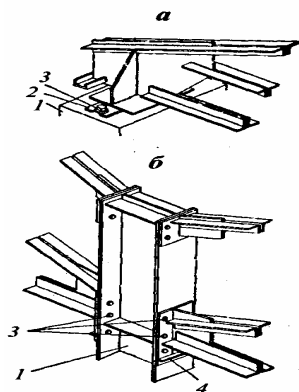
Сопряжение стропильных ферм с колонной:
